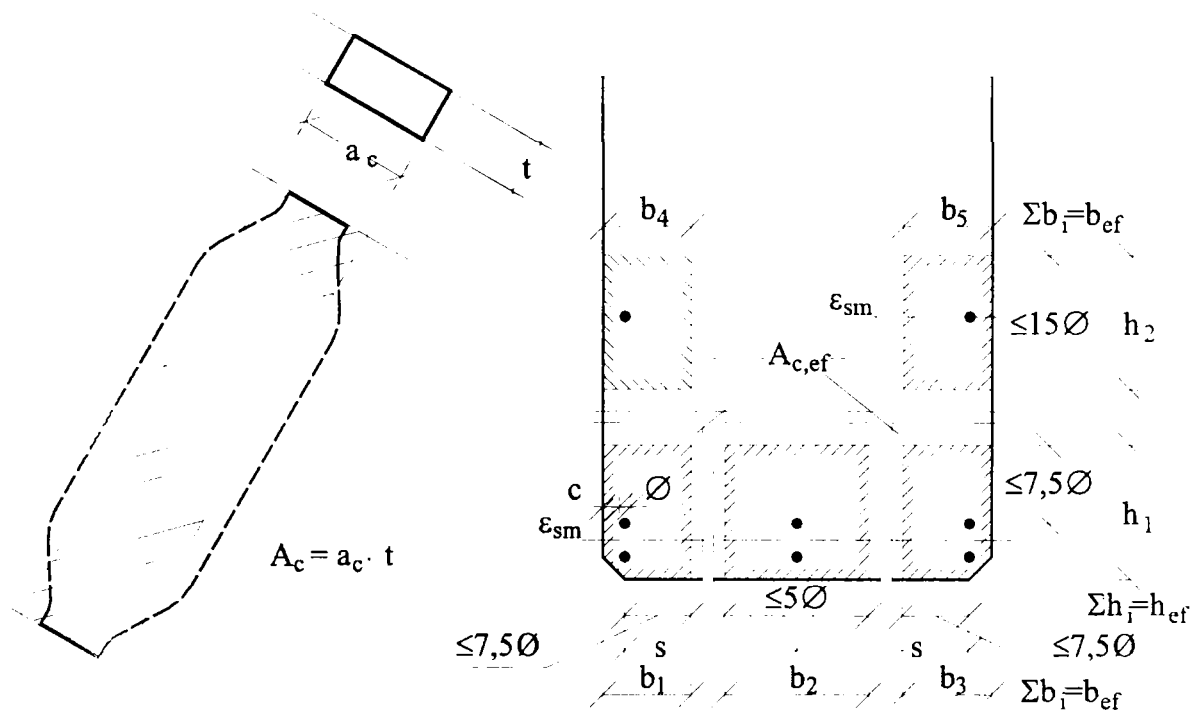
Bara comprimată de beton și modul de determinare a ariei de înglobare a armăturilor în beton
